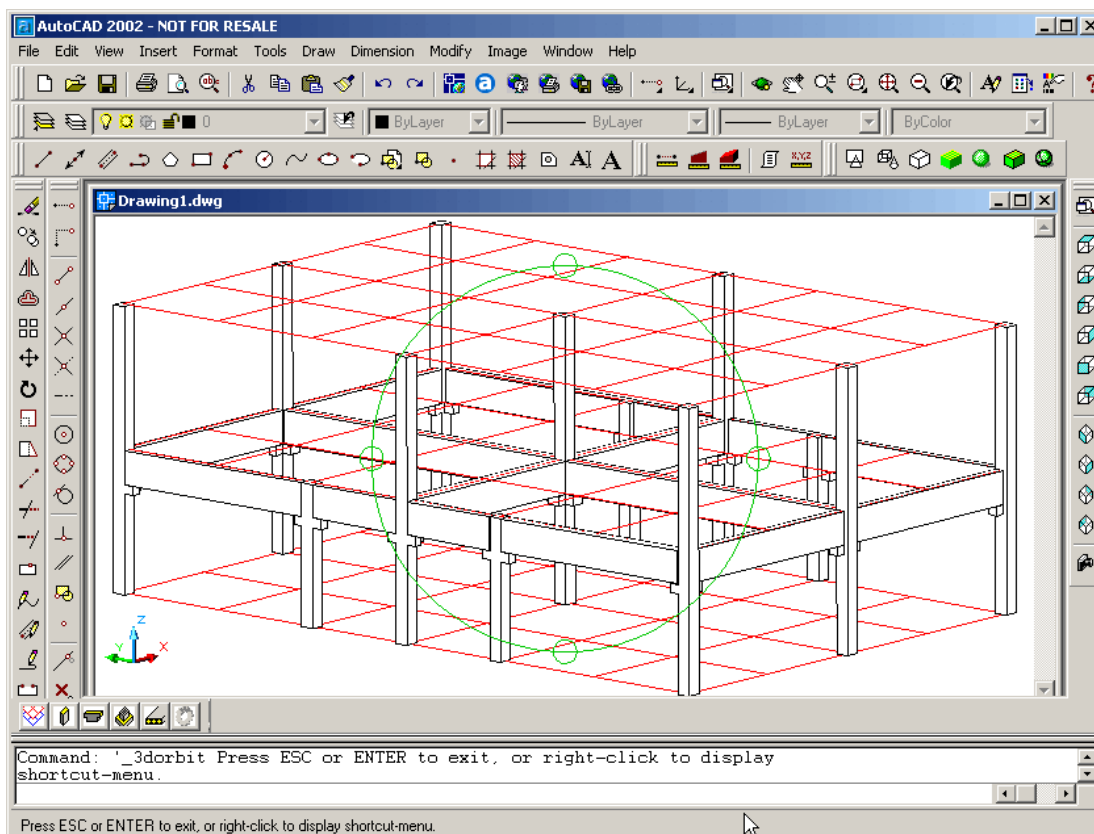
Pilares com vigas inseridas no primeiro pavimento.
